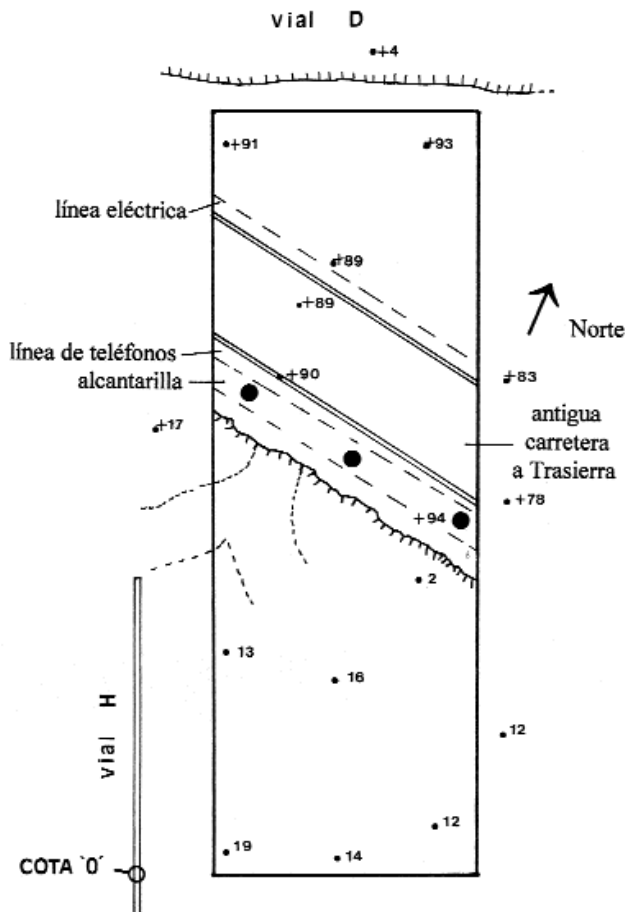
Plano de planta inicial y Cota "0" (1: 400)
